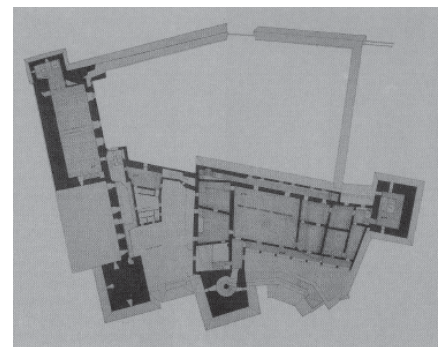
Planimetria del progetto di restauro del Castel Sismondo (in alto).
